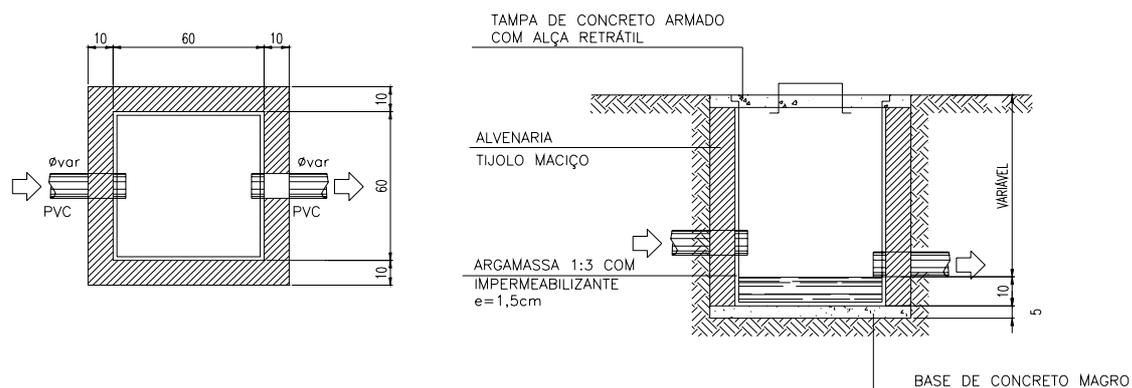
Exemplo de caixa de areia (planta baixa e corte).
